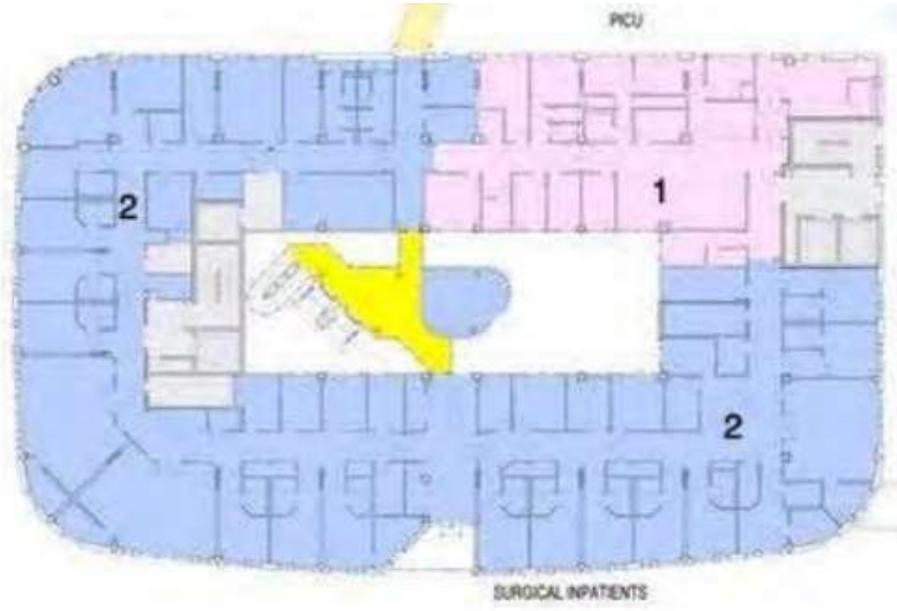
المسقط الأفقي للدور السابع
